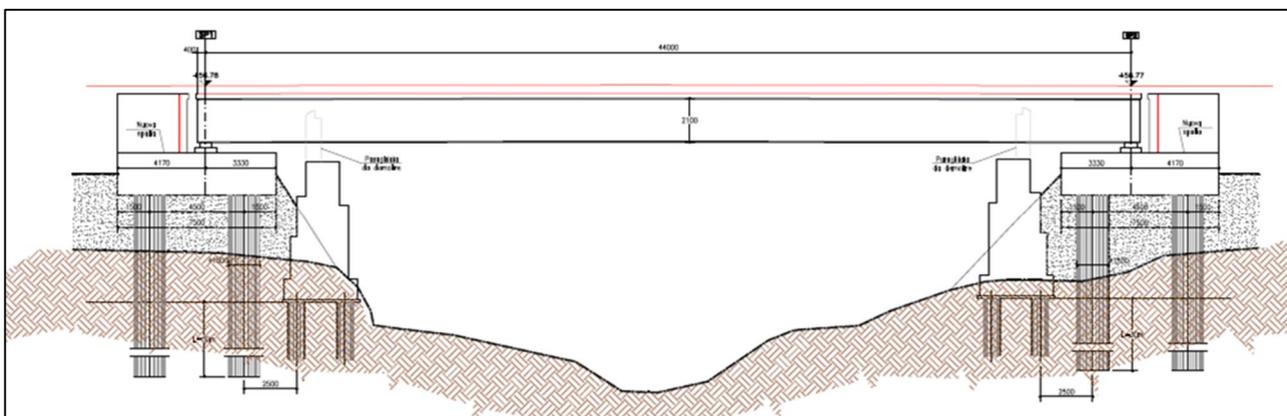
Sezione longitudinale dell'ampliamento del Ponte sul Torrente Savena
